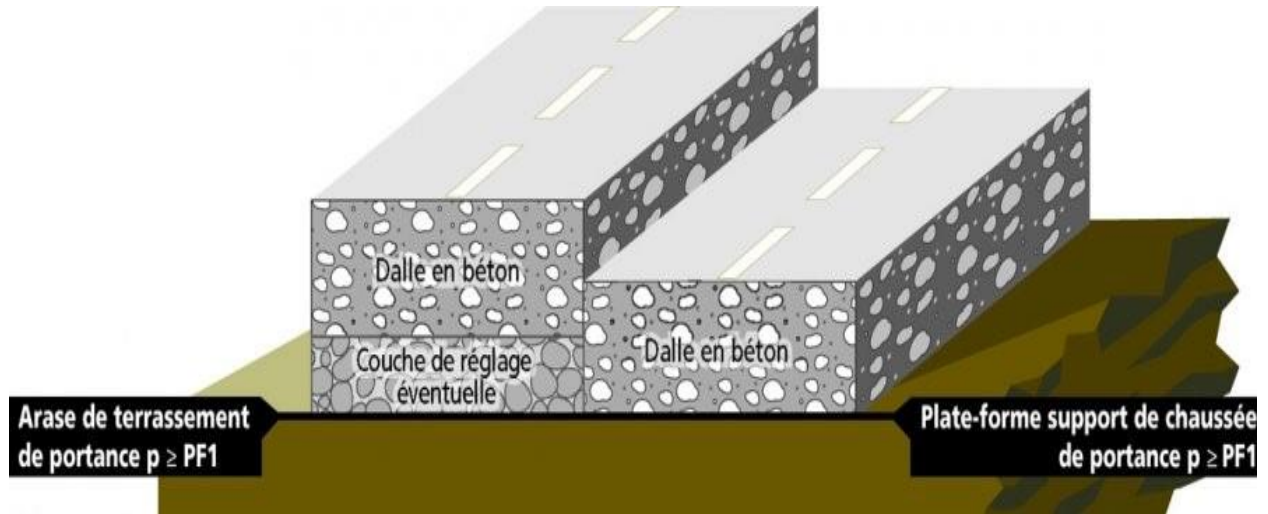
Structure type d'une chaussée rigide. [17]
